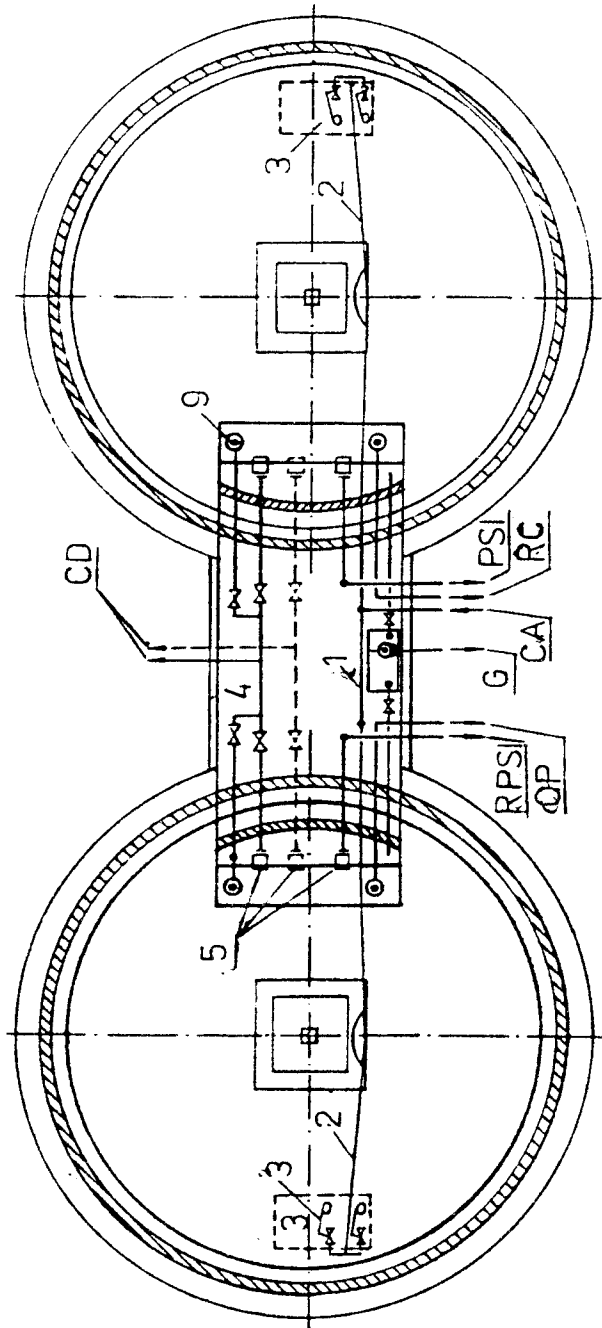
b. Instalația hidraulică la două rezervoare cuplate în paralel (vedere în plan).
